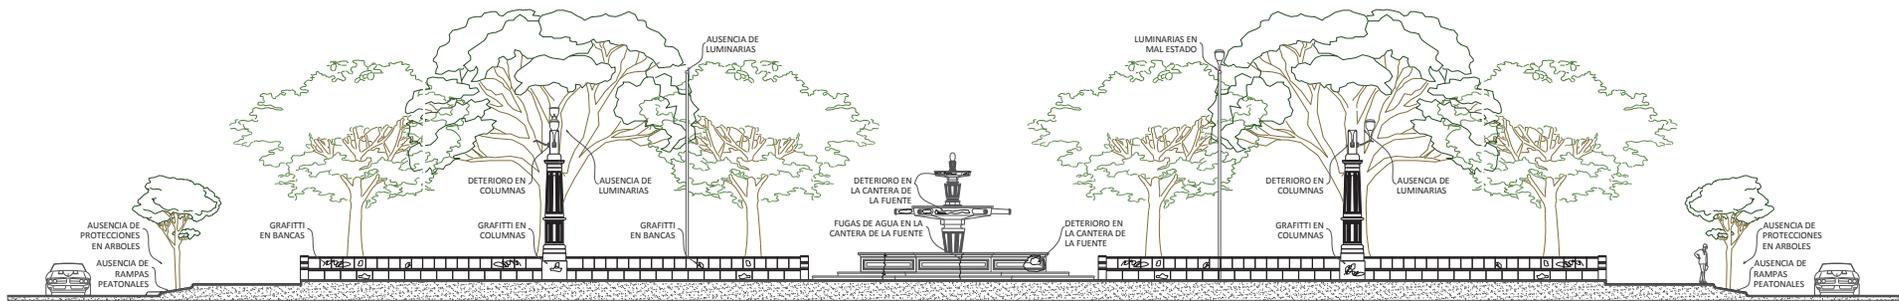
ALZADO DE LA VISTA NORTE DE LA PLAZA CARRILLO. Autor: Getzemani Sánchez Franco.
